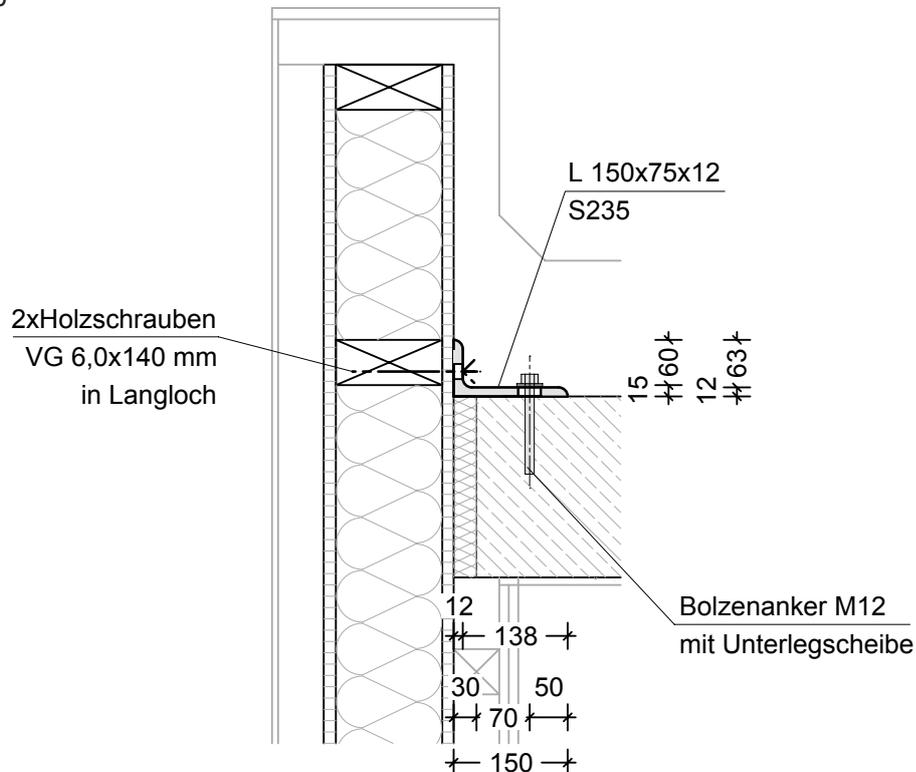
Verbindungsmitteldetail - Geschossdeckenanschluss mit Randunterzug
